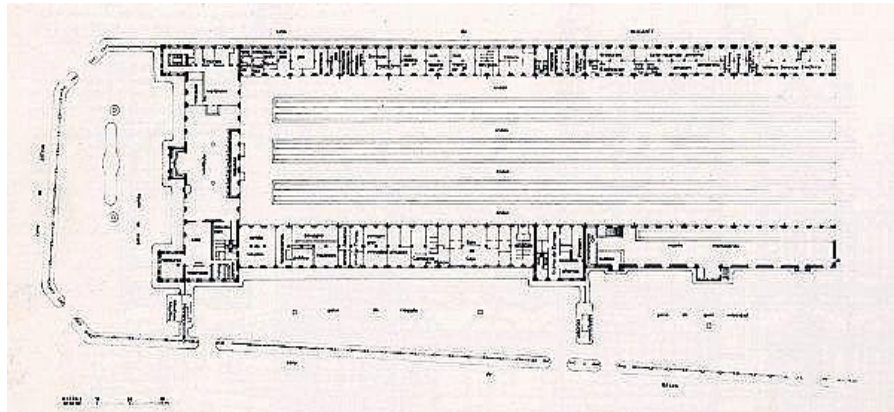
Planta baja. Proyecto definitivo E. de Valencia. FFE – 2008.
